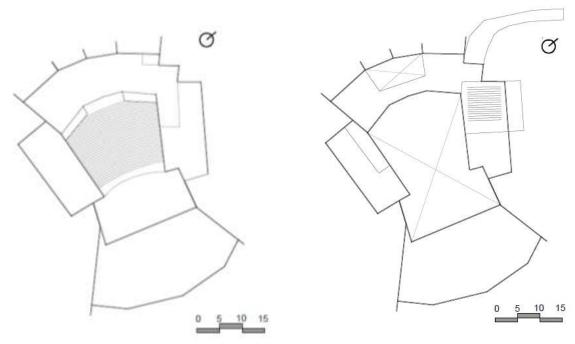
À esquerda: Planta esquemática do pavimento térreo – Sala Palma de Ouro. À direita: Planta esquemática do 1º pavimento – Auditório Paulo Freire e Secretaria da Educação.
